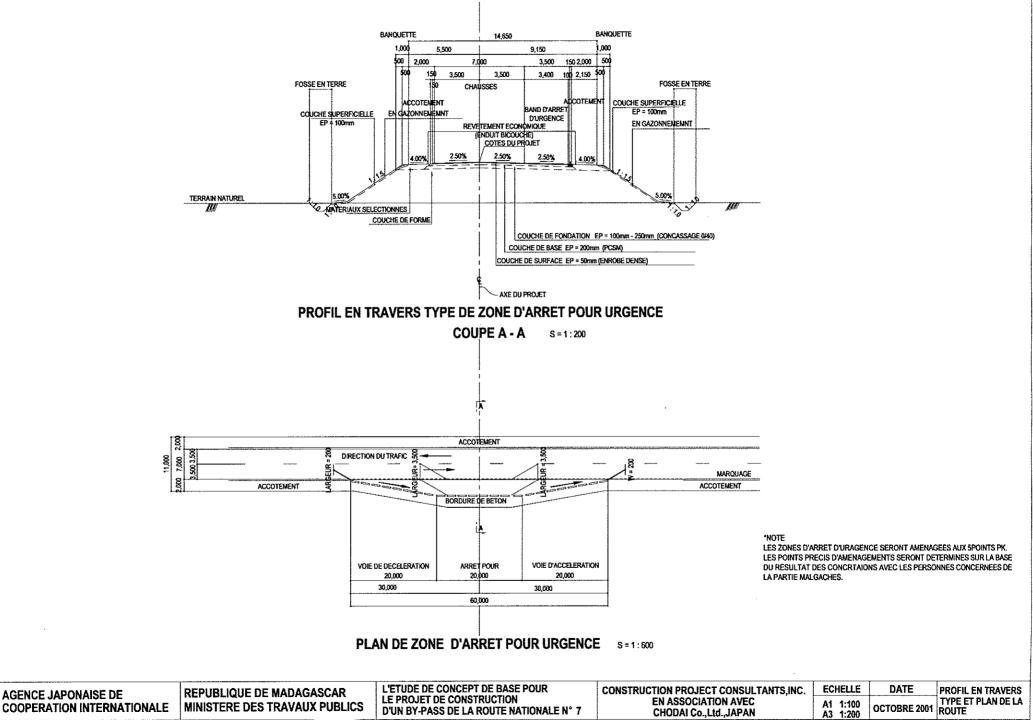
Profils en Travers Type et Plan de la Route (Le Zone D'arret pour Urgence)
